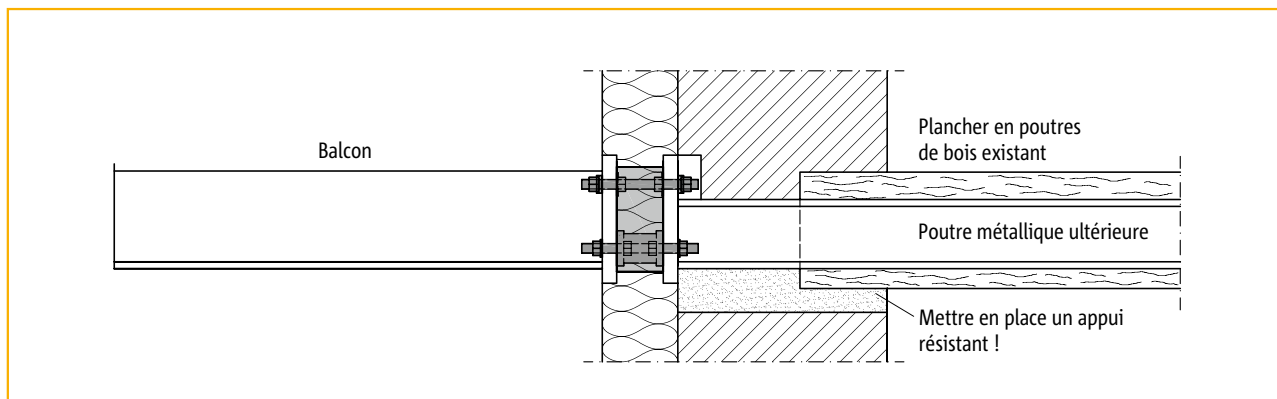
balcon en porte-à-faux, raccordé à un plancher en poutres de bois avec modèle KST (balcon en acier)
